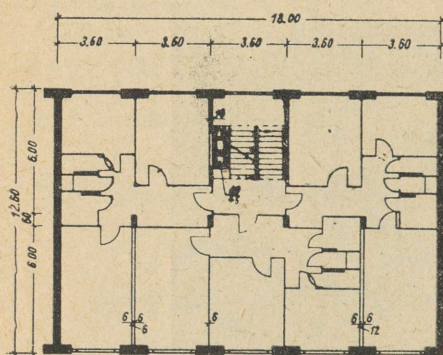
План жилого дома из кирпичных блоков с внутренним каркасом.
